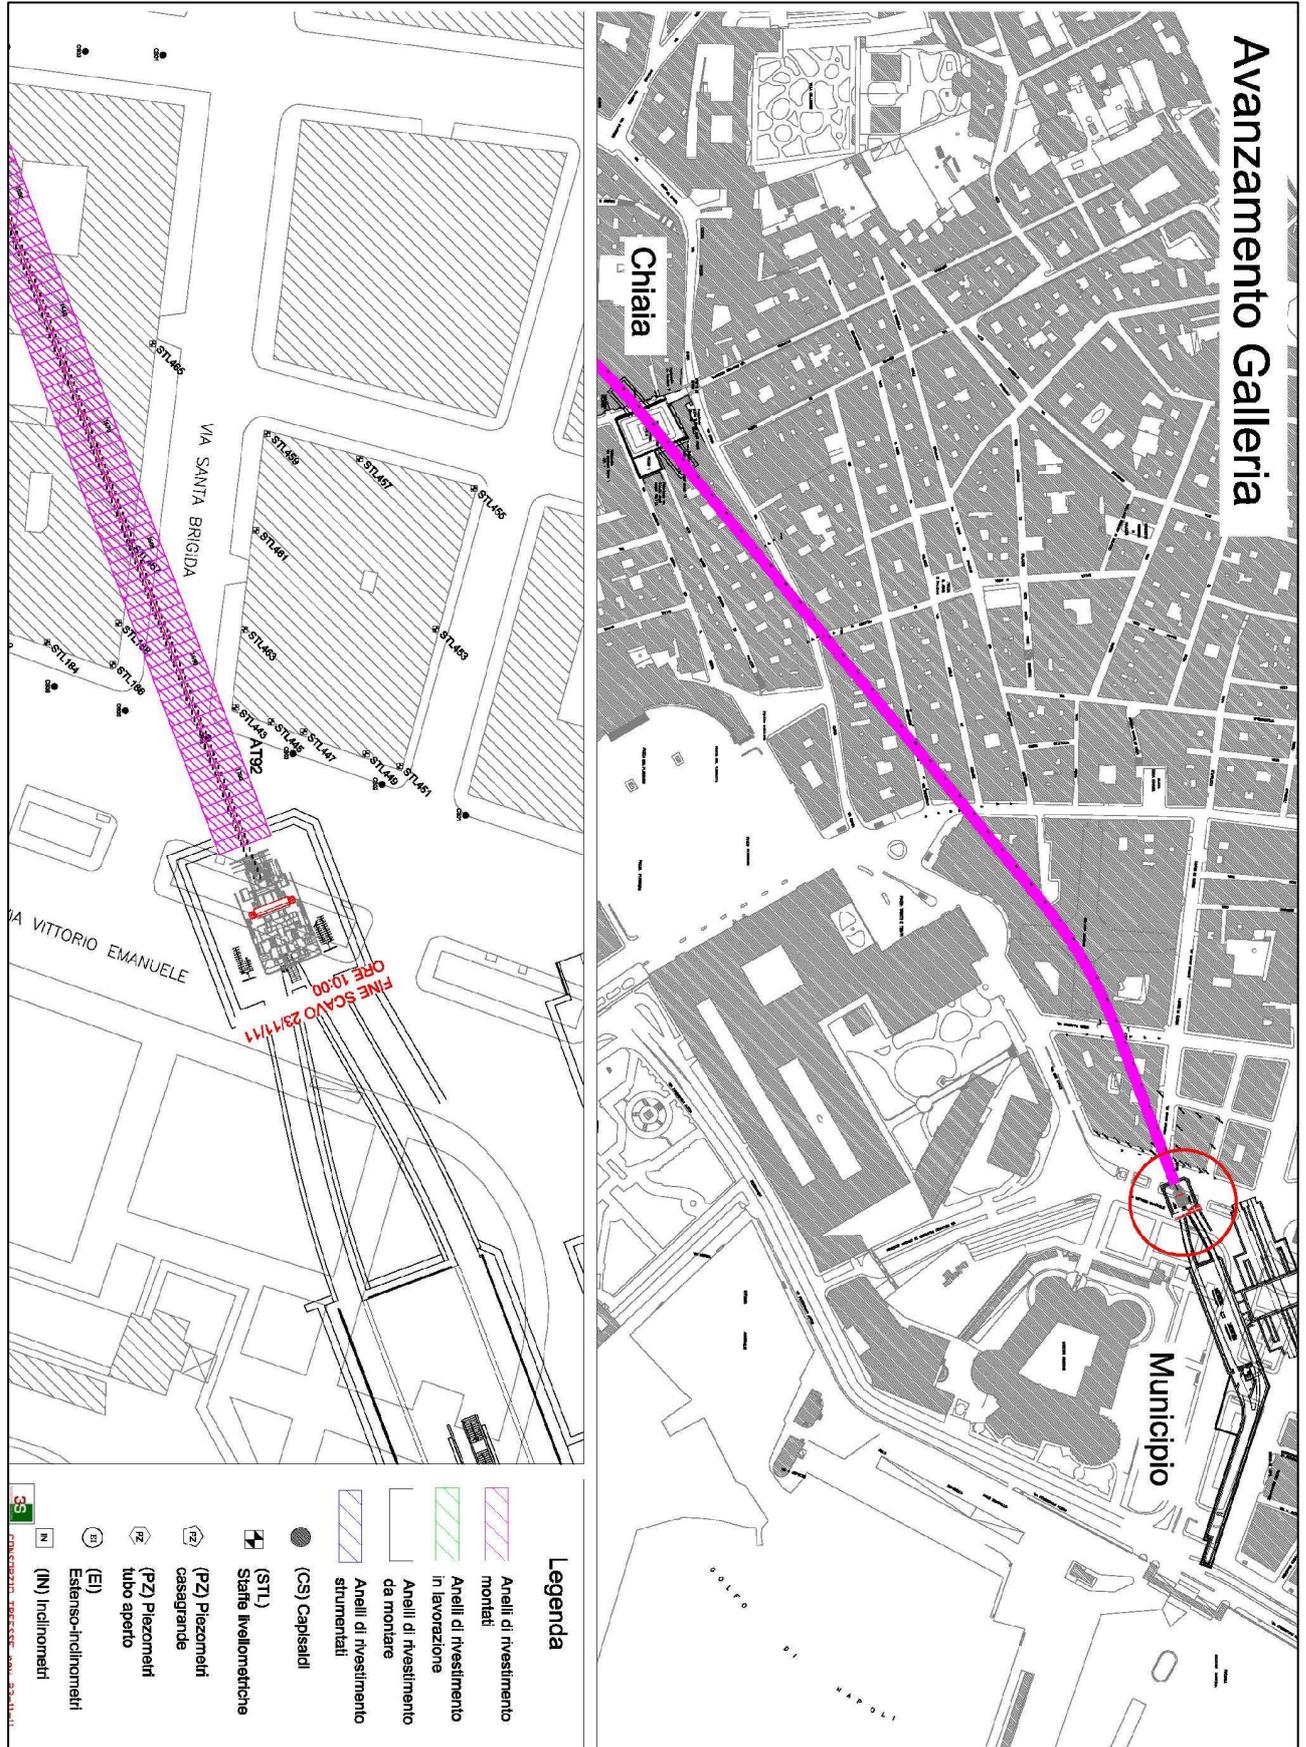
Planimetria avanzamento galleria al 23/11/11.
